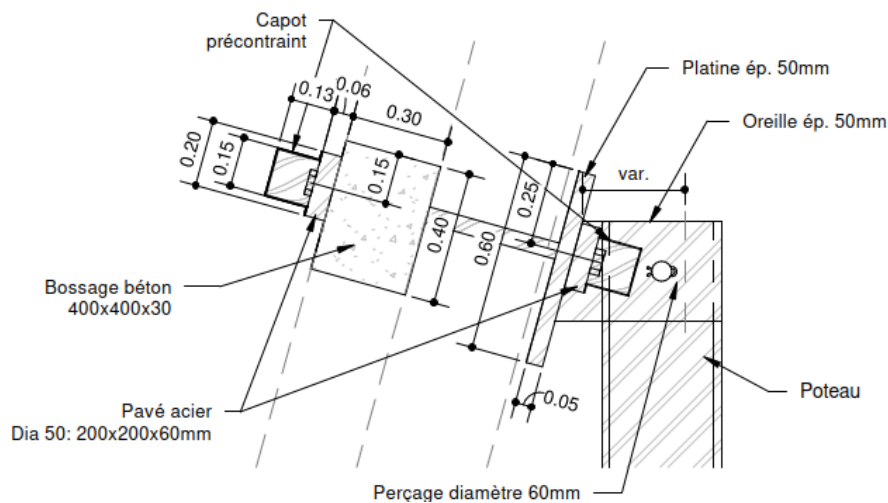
Coupe type de l'ancrage en partie haute pour une console accrochée sur un voussoir courant
